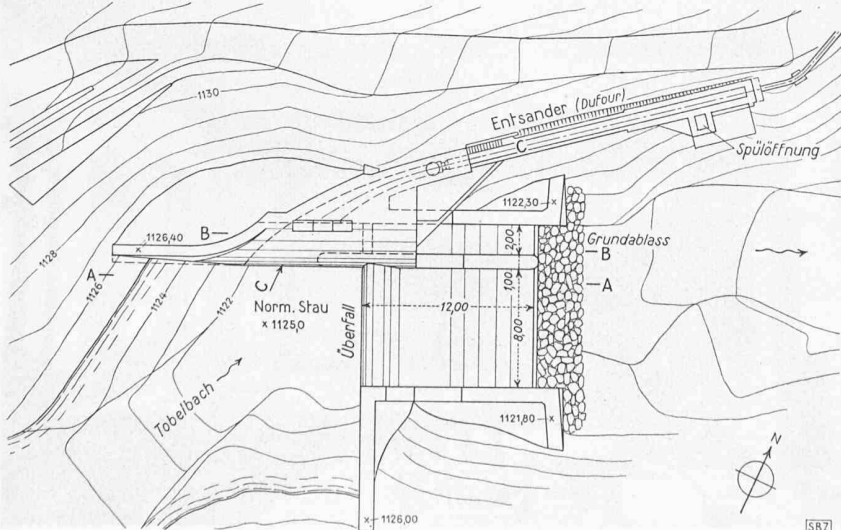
E. W. Buchs i. Rh., umgebaute Wasserfassung, Grundriss 1 : 500
